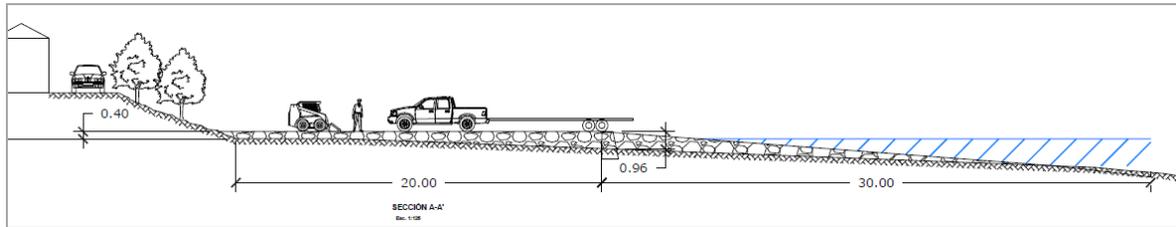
Sección A-A' Perfil Transversal Pavimento y Rampa, Laguna de Metapán.
